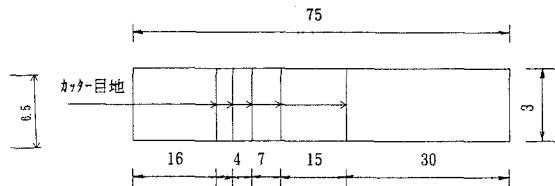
カッターマー目地を施した舗装平面図 (単位:m)
